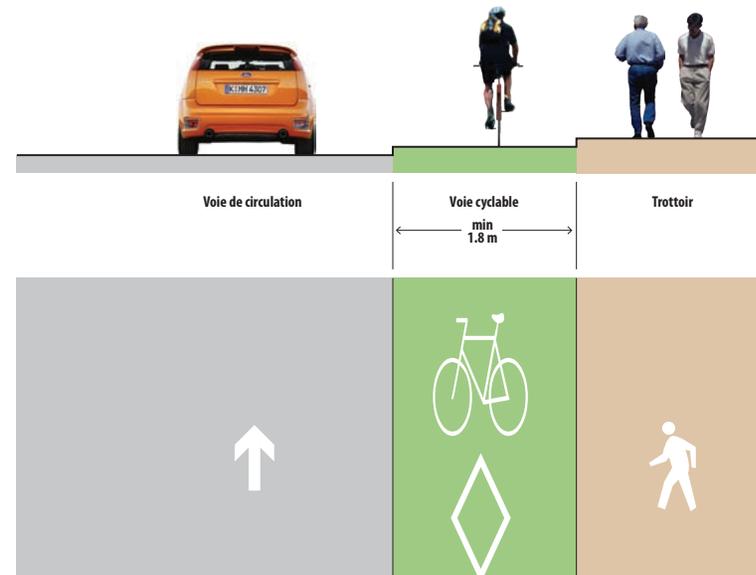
Installation unidirectionnelle séparée verticalement sans stationnement
